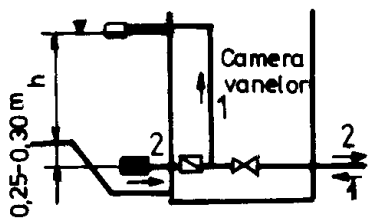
Schema instalațiilor la rezervoare tampon.
